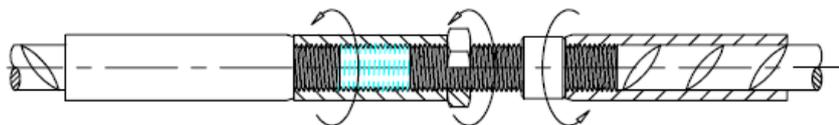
DISTANZÜBERBRÜCKENDE POSITIONSVERBINDUNG (PII) (Alternativ)
